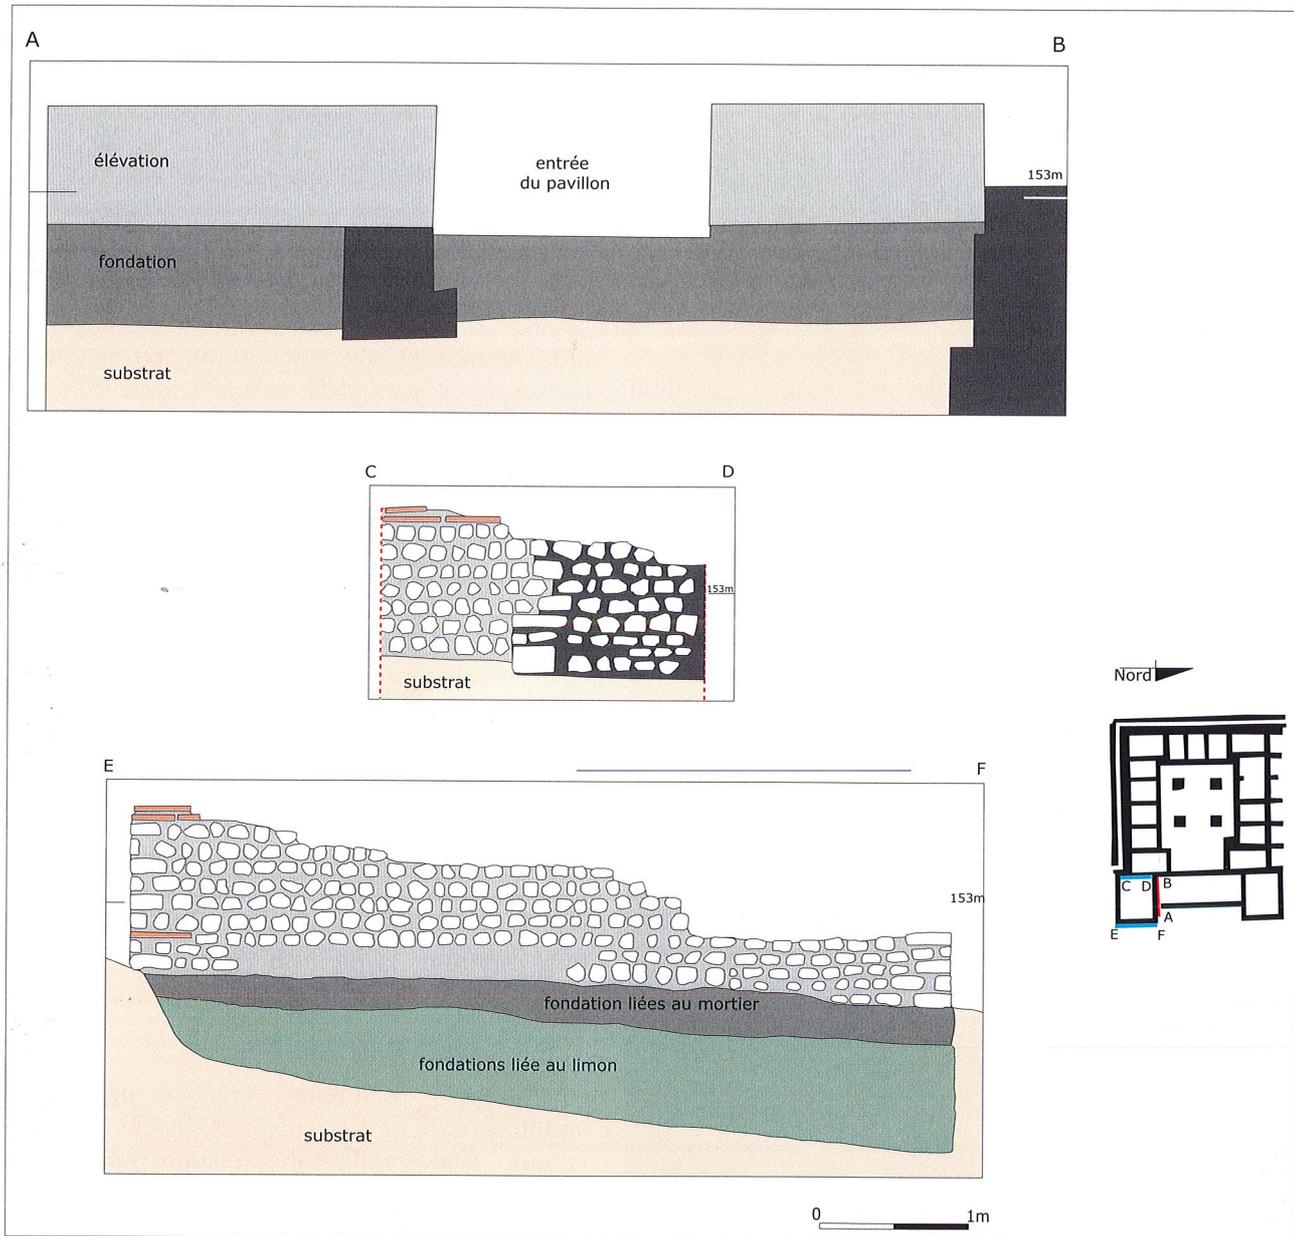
Coupes et élévation du pavillon sud. Infographie L. Grimbart INRAP.
